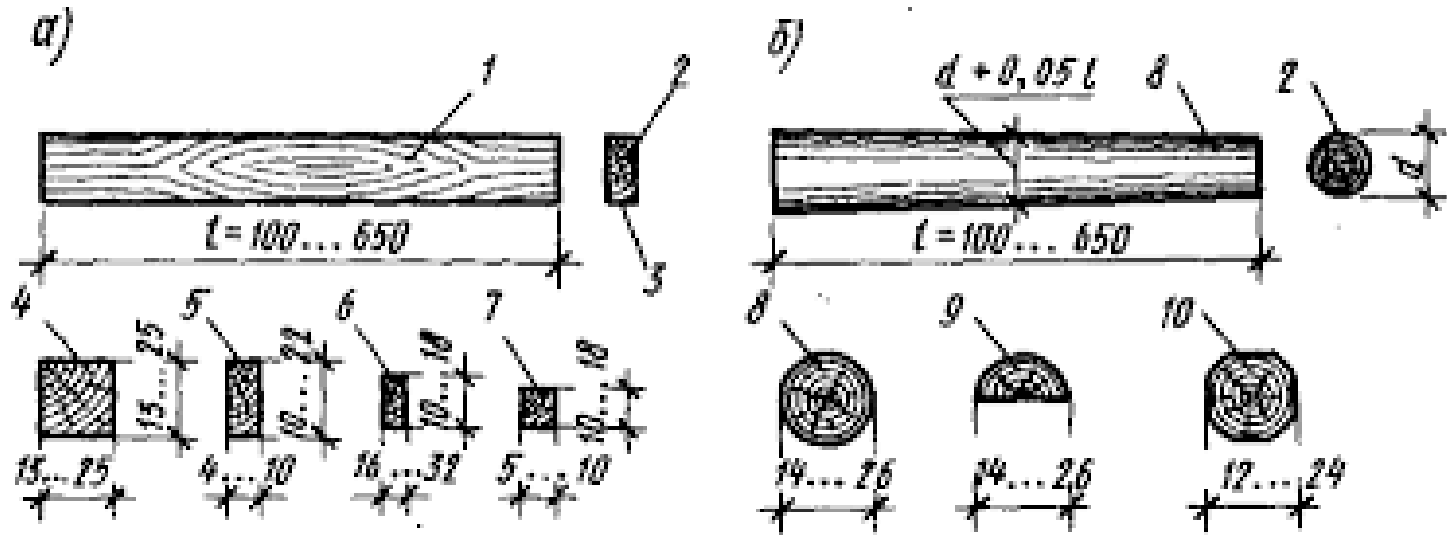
Лісоматеріали: а – пиляні; б – круглі; 1 – пласть; 2 – торець; 3 – кромка; 4 – брус; 5 – товста дошка; 6 – тонка дошка; 7 – брусок; 8 – колода; 9 – пластина; 10 – колода окантована.
